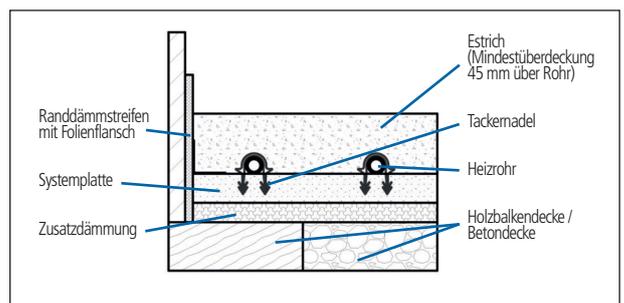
Aufbau der Bauart A einer Fußbodenheizung/-kühlung in Nassbauweise
